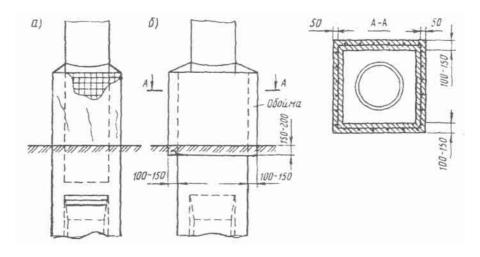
Ремонт стаканного фундамента путем установки железобетонной обоймы: а — поврежденная часть фундамента; б — фундамент с обоймой
